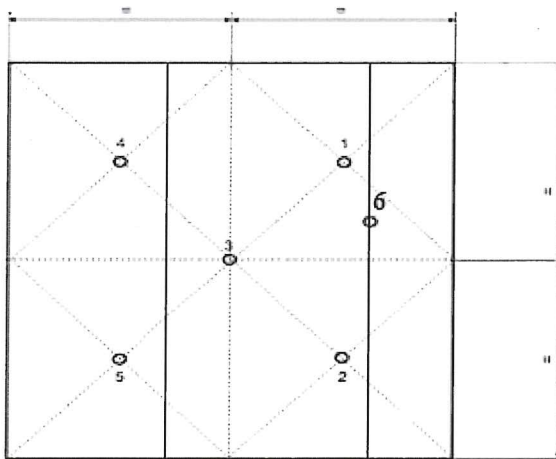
Схема расположения термопар на необогреваемой поверхности образца.
